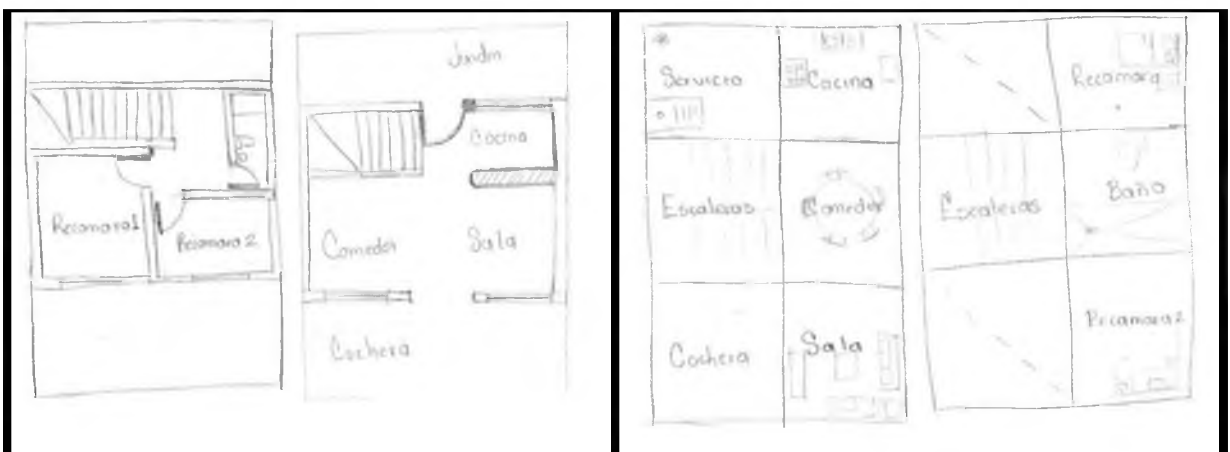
y 41. Bocetos que contemplan dos Plantas Arquitectónicas. Diseñadas por autor.
